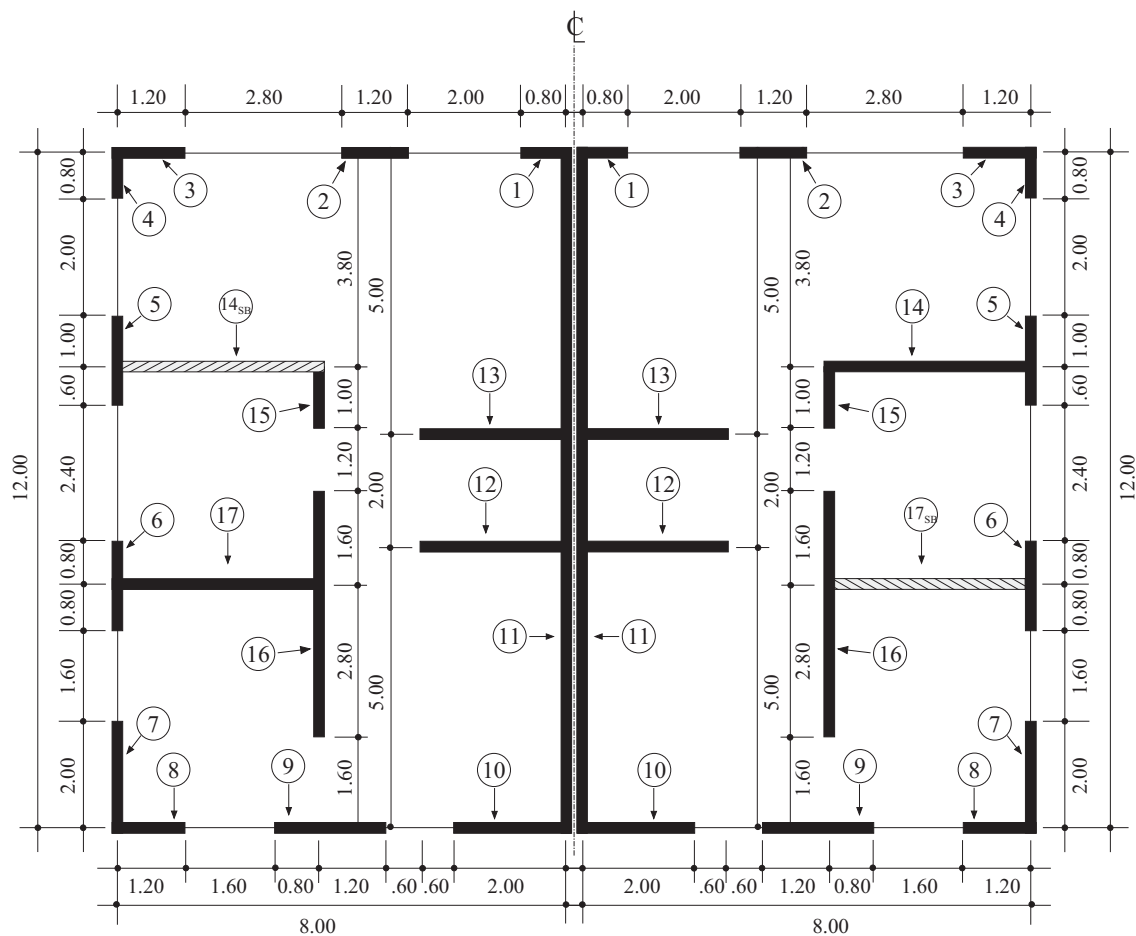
Grundriss des vierstöckigen Beispielgebäudes, Abmessungen in m
